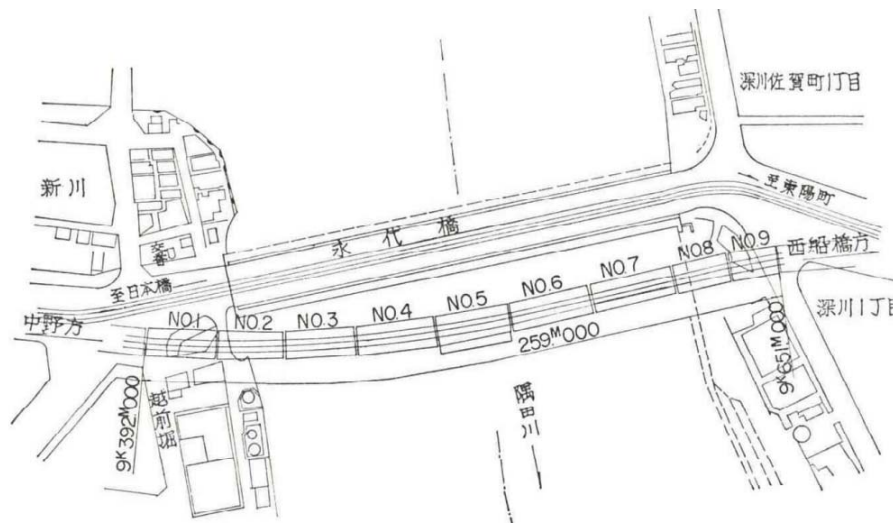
ケーソントンネル平面図の例⁴⁾
